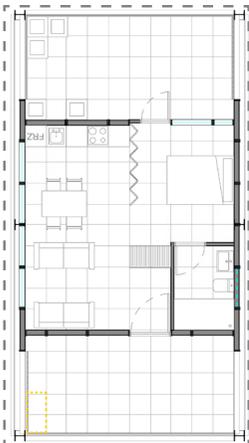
Plantas de ubicación de residuos en tipologías A
